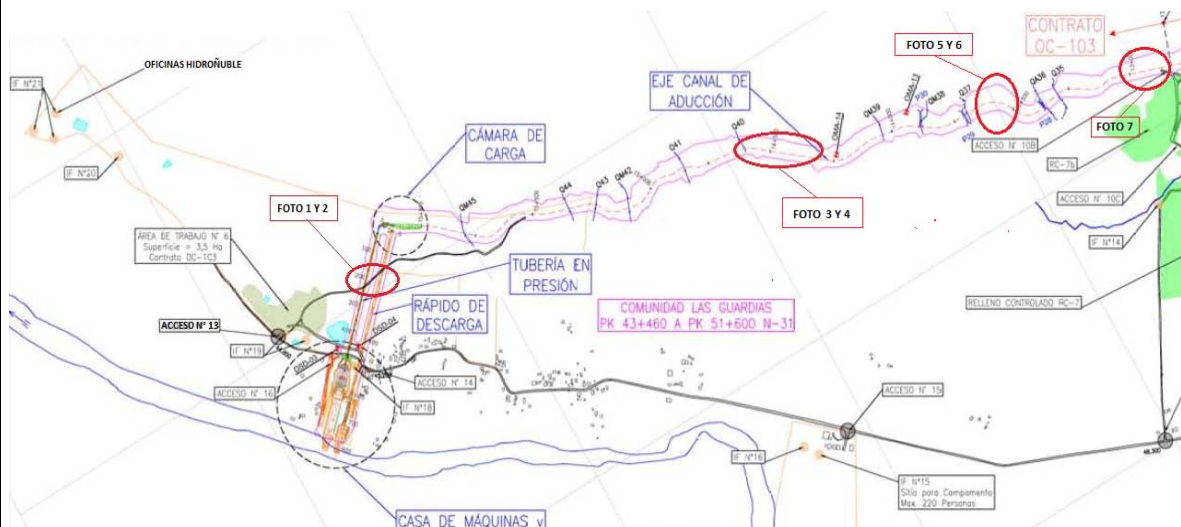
Planos de la Obra Hidroñuble, tramo OC-103.
